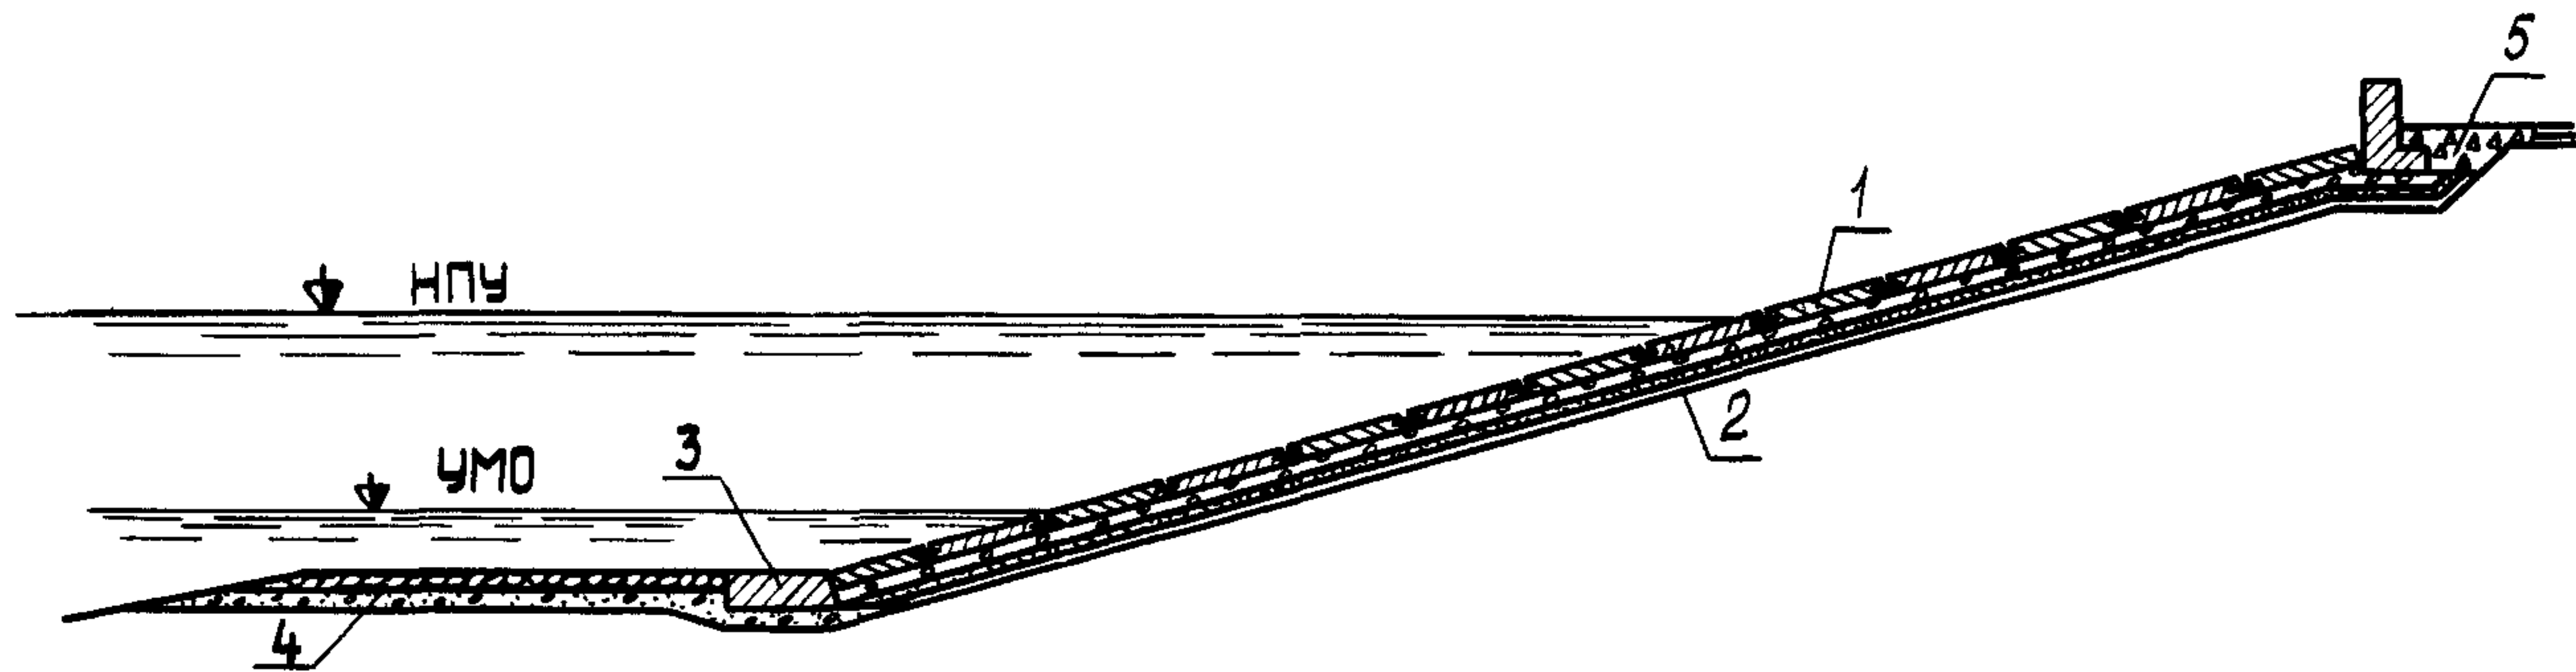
Пример конструкции сквозного крепления откоса с применением сборных железобетонных плит:
